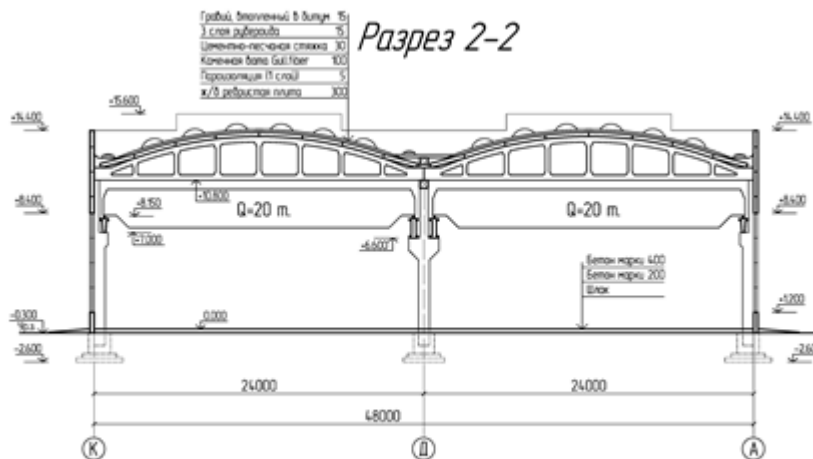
Пример поперечного разреза двухпролётного промздания в железобетонных конструкциях с мостовыми кранами и зенитными фонарями.
